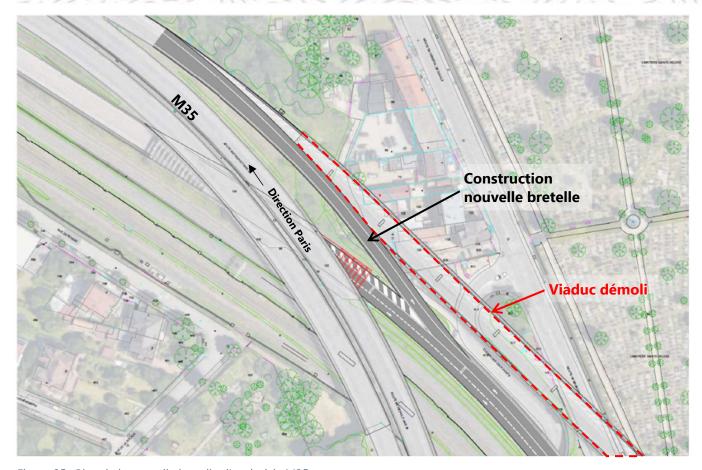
Plan de la nouvelle bretelle d'accès à la M35
